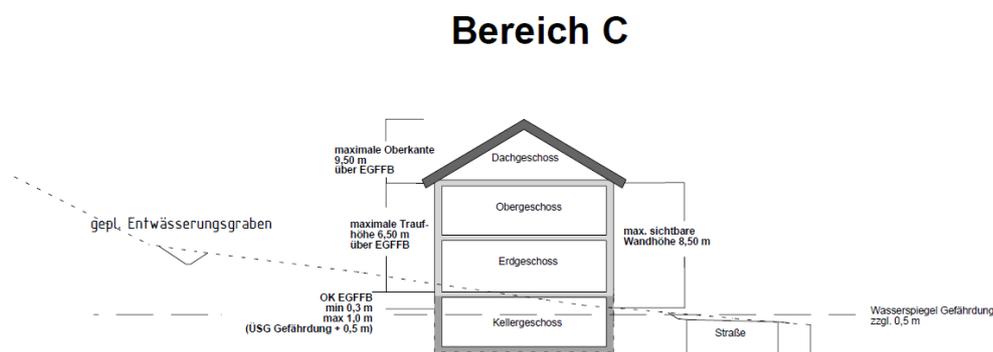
Schnittdarstellung Bereich C mit Gebäuden mit geneigtem Dach
